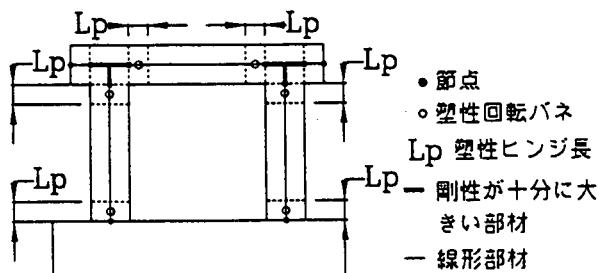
鉄筋コンクリートラーメン橋脚の骨組モデル
